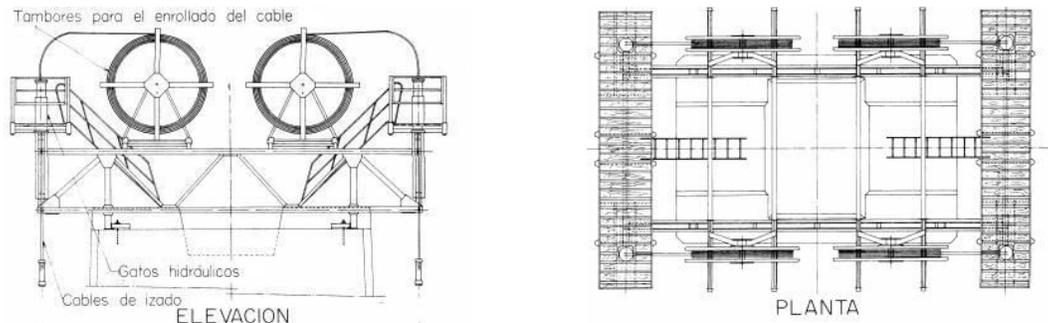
Dispositivo de izado de la cimbra de la dovela de pila, puente Metlac
